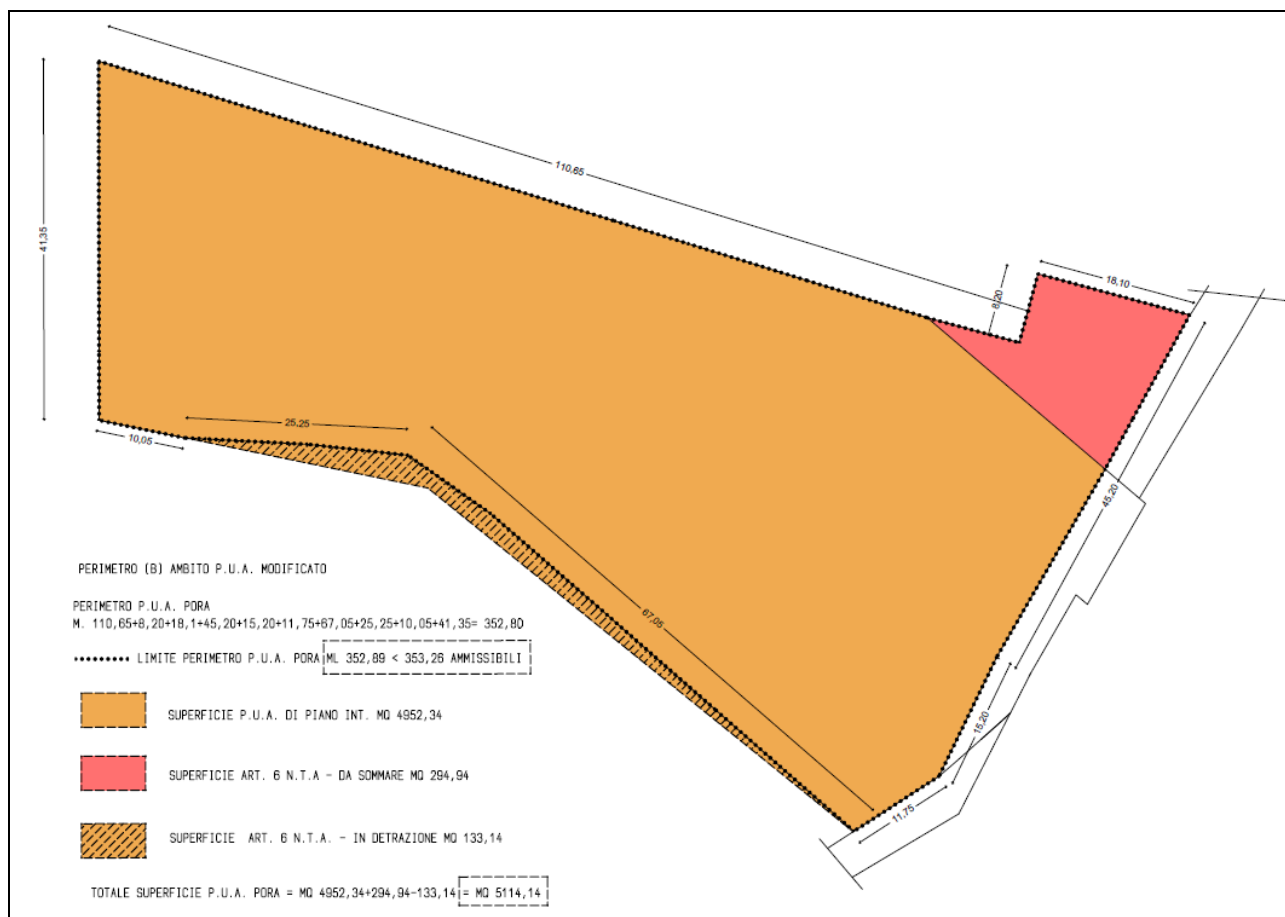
Planimetria generale area intervento con evidenziazione ampliamento superficie ex art. 6 delle Norme Tecniche del Piano degli Interventi
